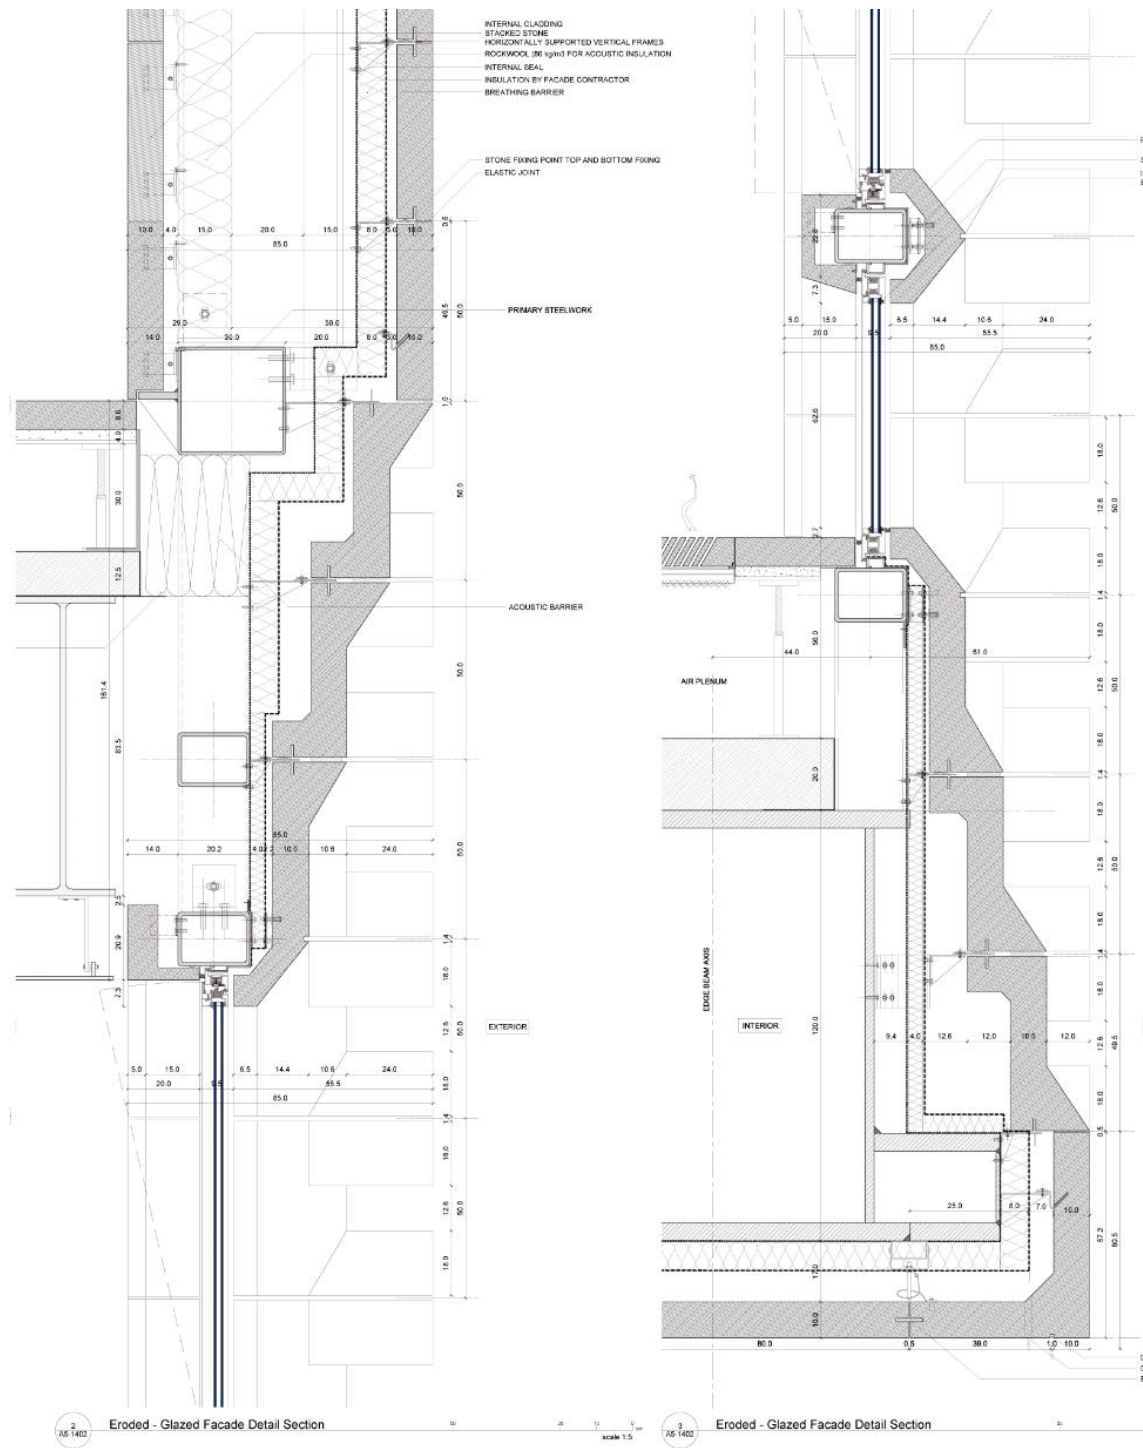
Secciones verticales en el edificio para el Nuevo Parlamento en Malta. Encuentro con carpintería y remate inferior. <https://arquitecturaviva.com/obras/puerta-de-la-valeta>. (Consulta el 08.09.2020)
